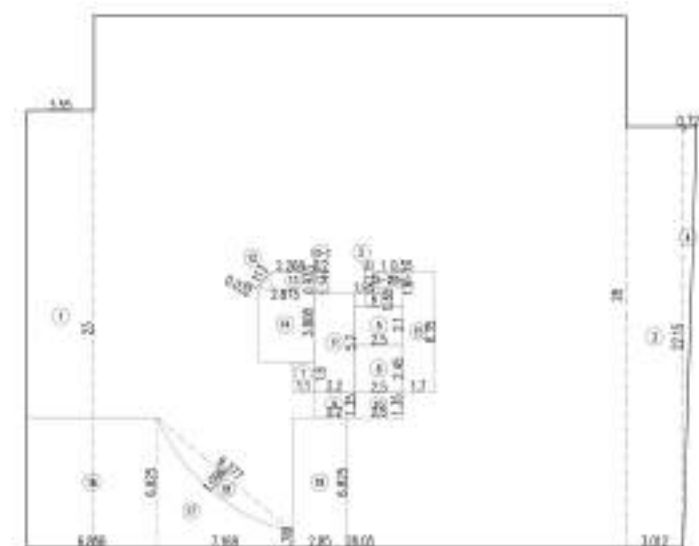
地下 5 層平面圖 (比例尺 1/200)
